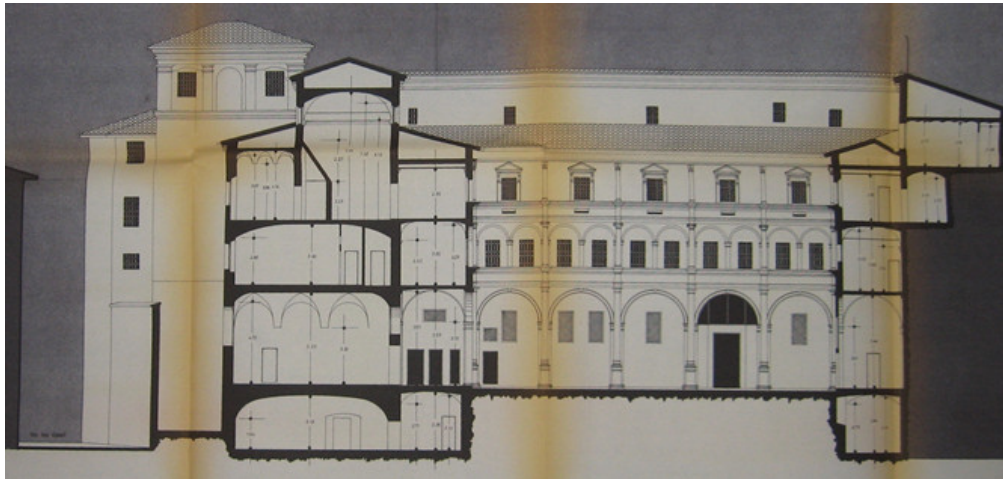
Sezione A-A del progetto esecutivo (2° Lotto).
